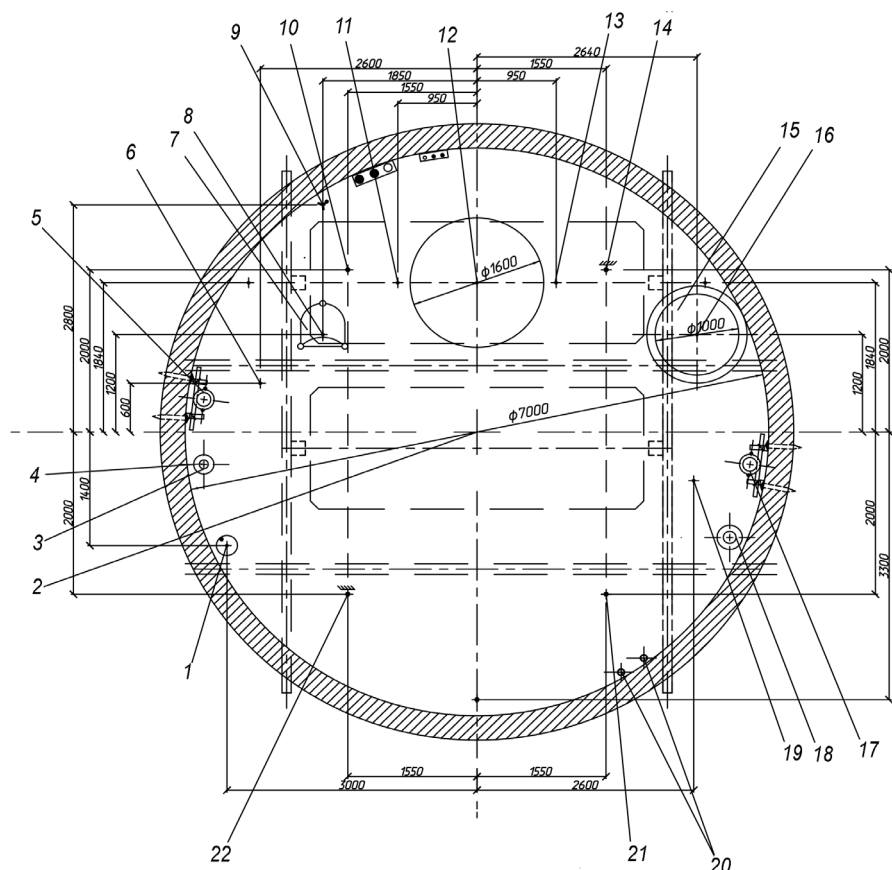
Размещение горнопроходческого оборудования и канатов в сечении вертикального ствола: 1 и 2 – канаты подвески кабеля взрыва и центрального отвеса; 3 и 4 – трубопровод водоотлива и узлы крепления; 5, 17 – трубопроводы подачи бетона и их узлы крепления; 6, 16, 19 – канаты наращивания трубопроводов; 7 – спасательная лестница; 8 – канат подвески спасательной лестницы; 9 – канат подвески группы кабелей (силовой, стволовой сигнализации, телефонизации, блокировки и газовой защиты); 10, 14, 21 – канаты подвески проходческого полка; 11, 13, 22 – канаты подвески секционной опалубки; 12 – канат подъемный; 15 – трубопровод вентиляции и узлы крепления; 18 – трубопровод сжатого воздуха и узлы крепления; 20 – трубопроводы цементации (подачи воды) и узлы их крепления.
